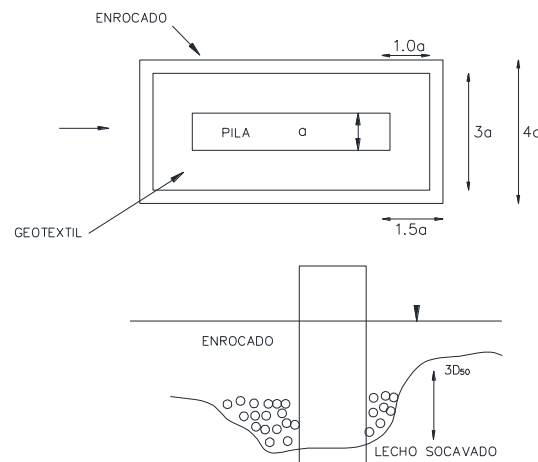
Enrocado colocado en excavación previamente hecha. A) Planta ($\phi=0$). Sección transversal. SAFL, (1998).
